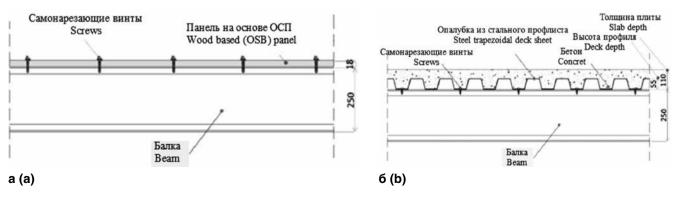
Конструкция плит перекрытий экспериментального образца LAMIEREDIL (размеры в мм) [33]:
